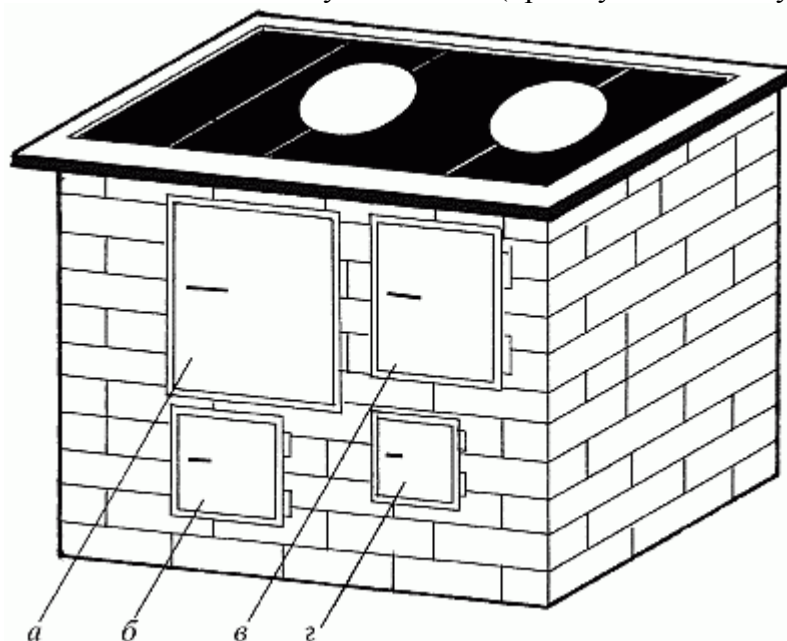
Кухонная плита с духовым шкафом: а – духовой шкаф; б – чистка; в – топливник; г – поддувало
